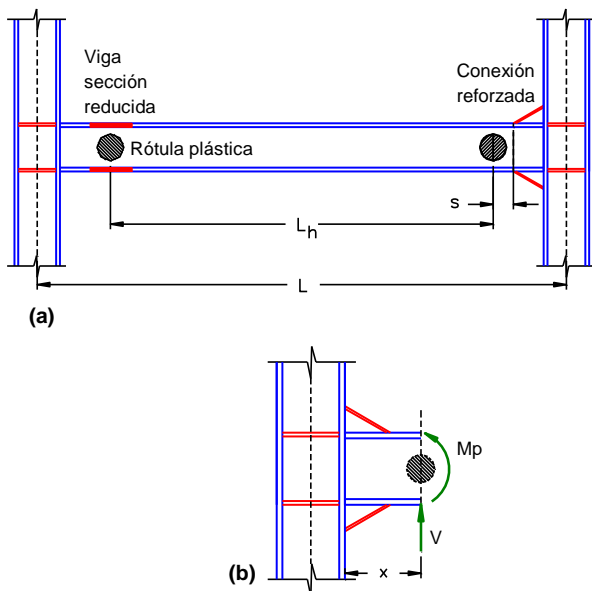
Ubicación de rótulas plásticas en vigas con distinto tipo de conexiones.
